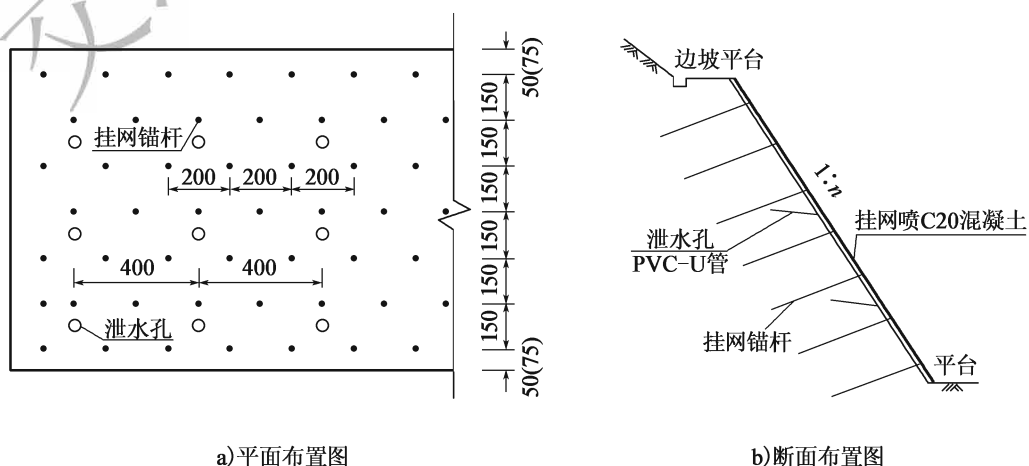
土工格栅喷射混凝土坡面防护结构形式(尺寸单位:cm)
